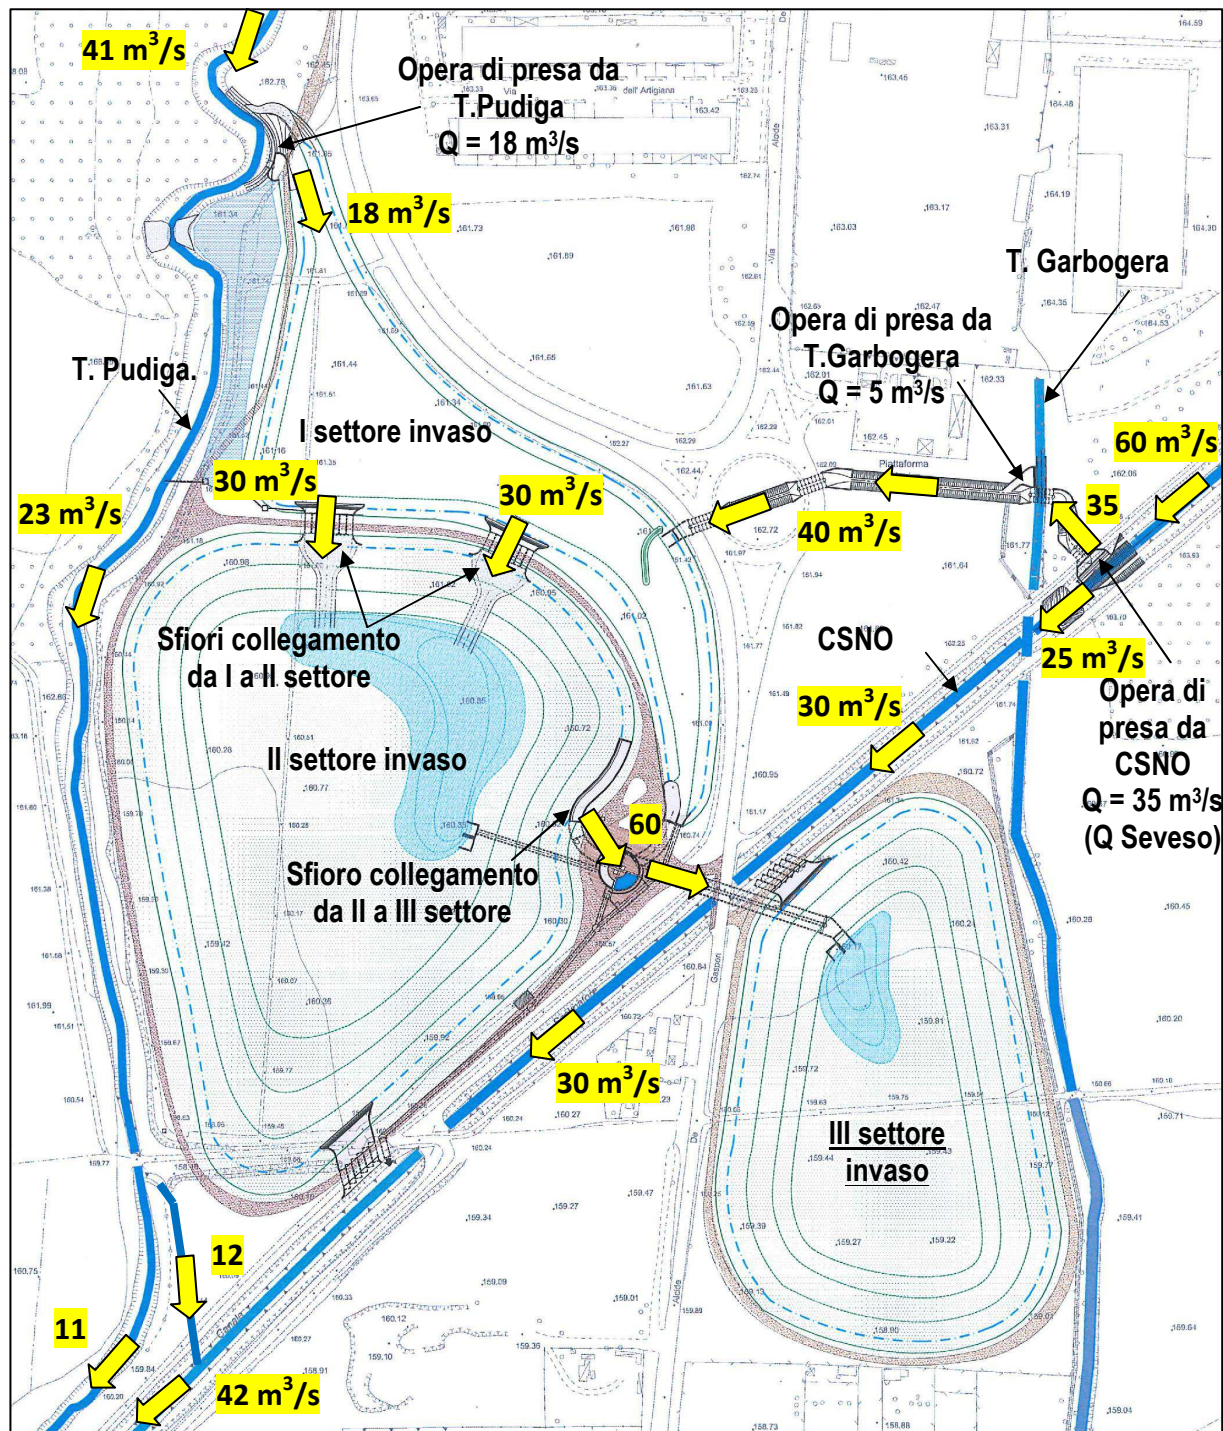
Schema planimetrico del sistema idraulico della vasca di laminazione di Senago
